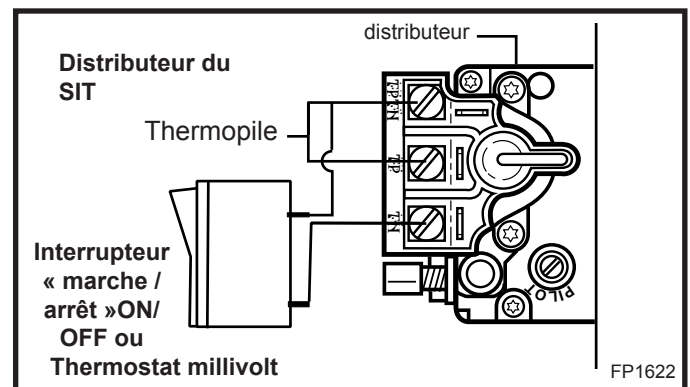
Installer le câblage de passer avant de se connecter à la distributeur.
